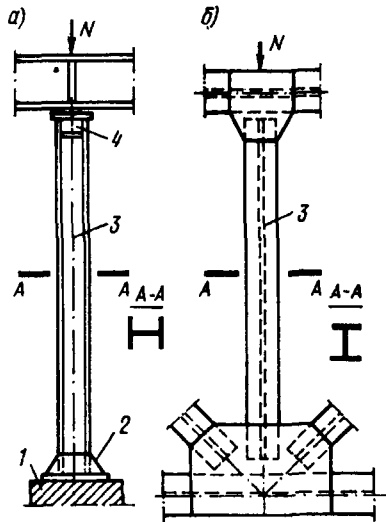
Схемы стержней, работающих на центральное сжатие
